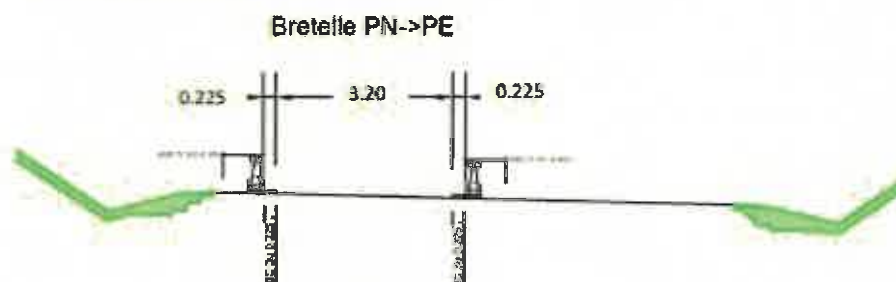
Profil type réduit sur bretelle PN->PE définitive
